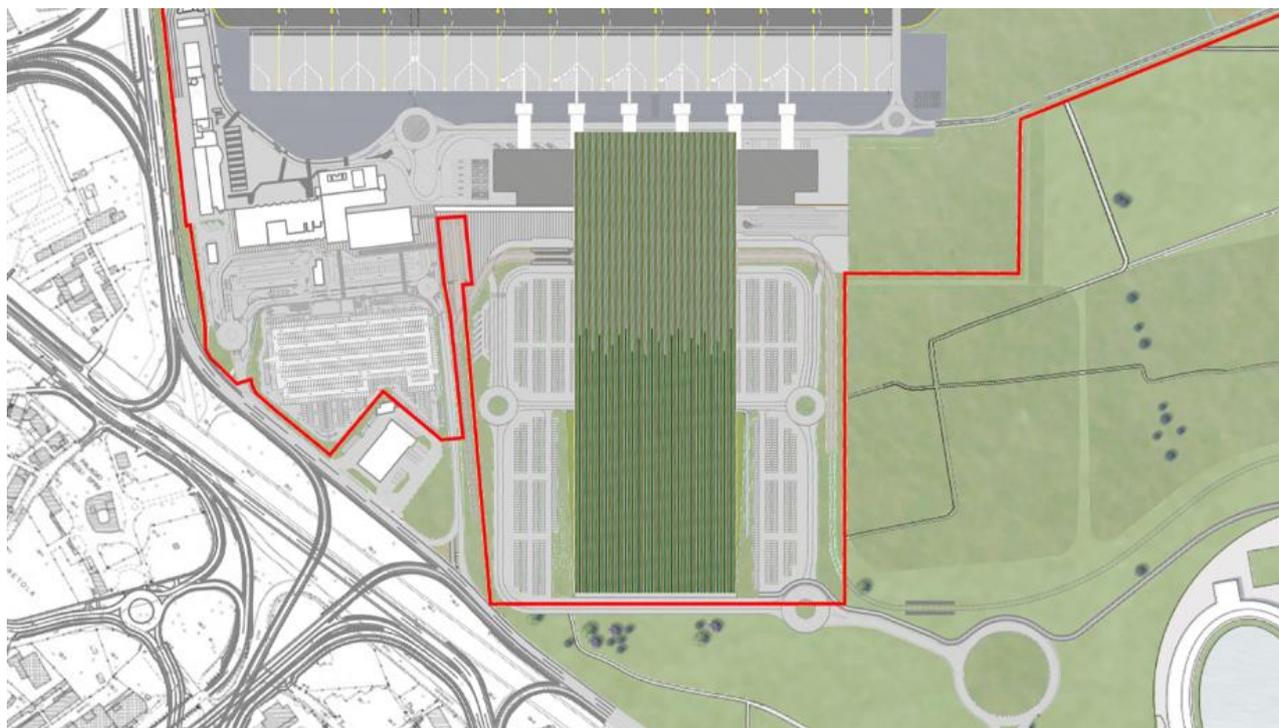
| Planimetria generale di Futura espansione Terminal e Piazzali al 2035
